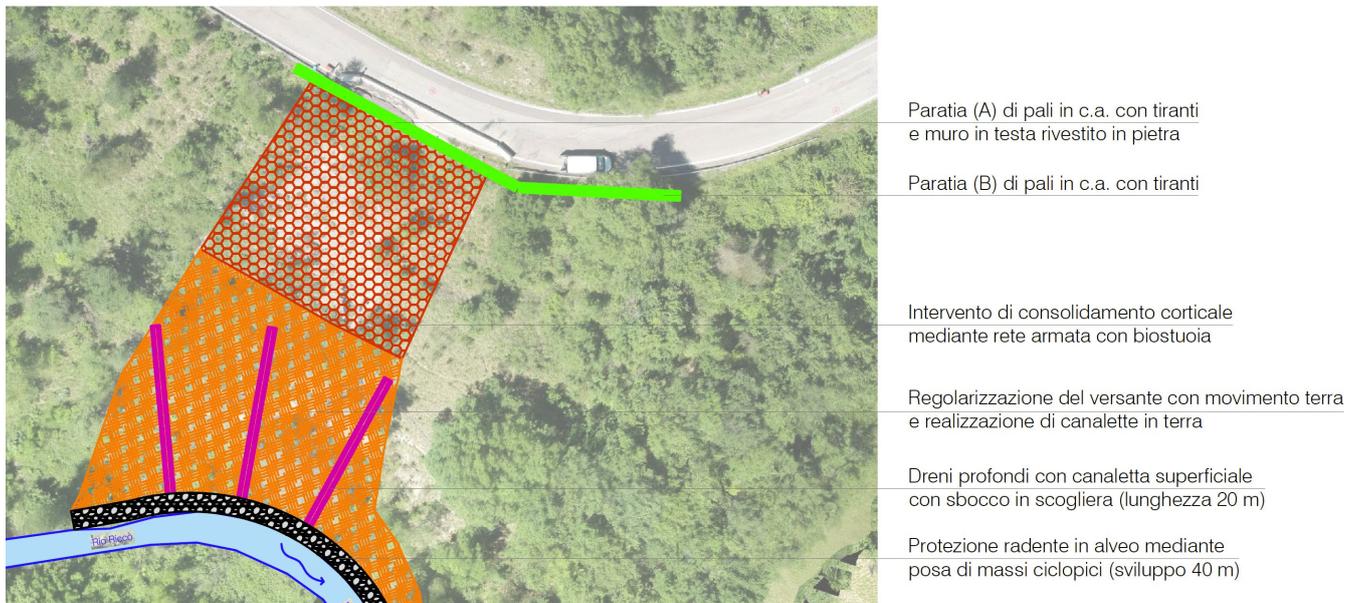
Ortofoto con indicazione degli interventi in progetto
